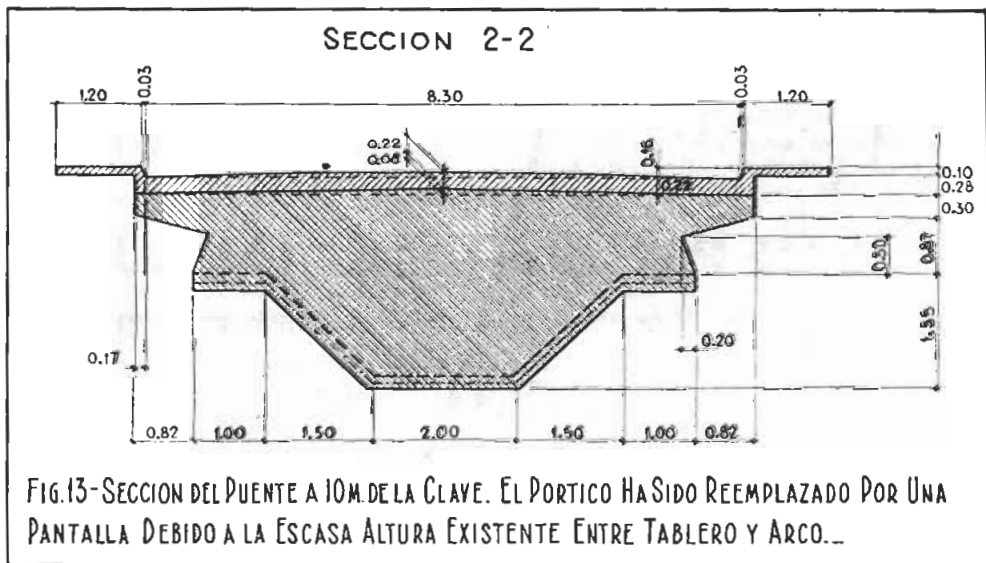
SECCION DEL PUENTE A 10M.DE LA CLAVE. EL PORTICO HA SIDO REEMPLAZADO POR UNA PANTALLA DEBIDO A LA ESCASA ALTURA EXISTENTE ENTRE TABLERO Y ARCO...
